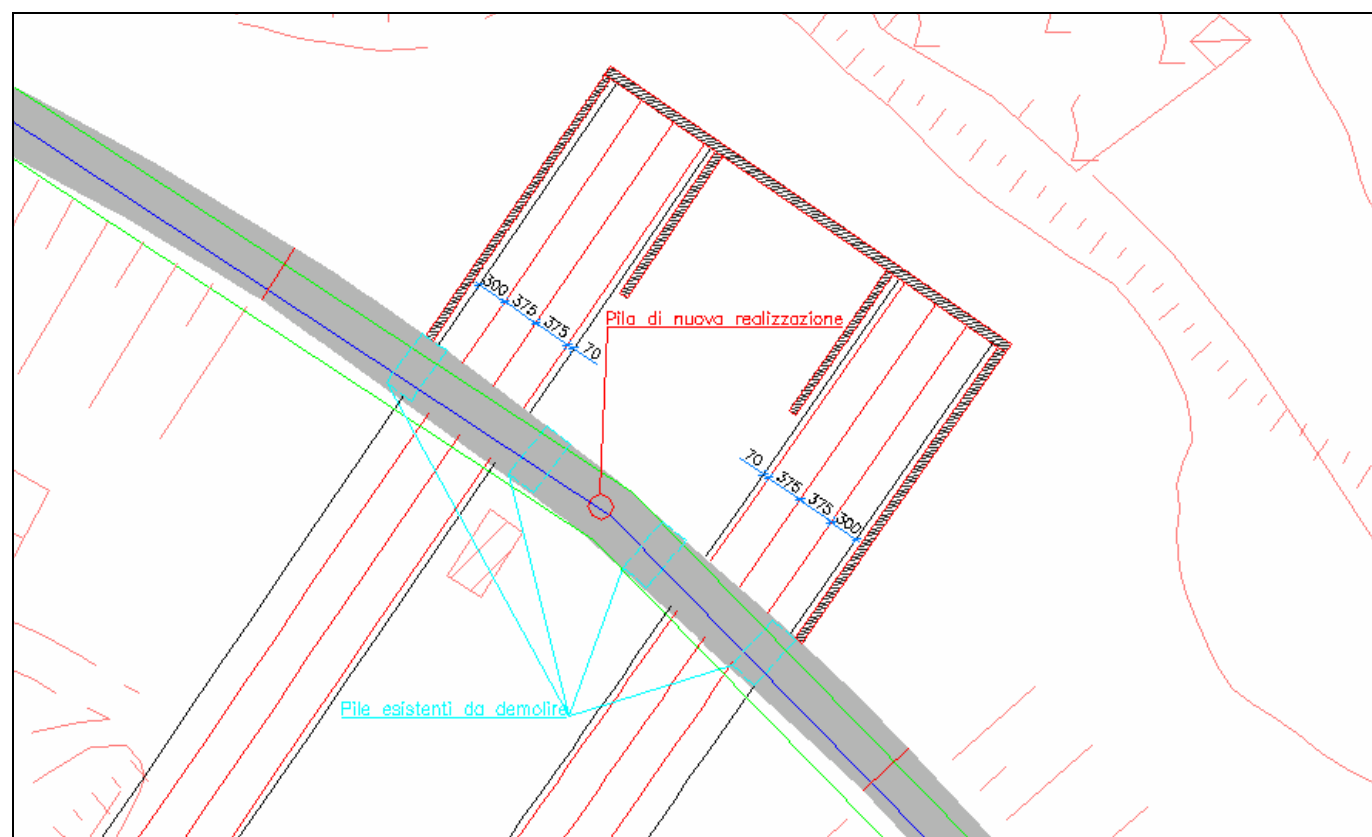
Planimetria del nuovo ponte ferroviario (km 11+820)
